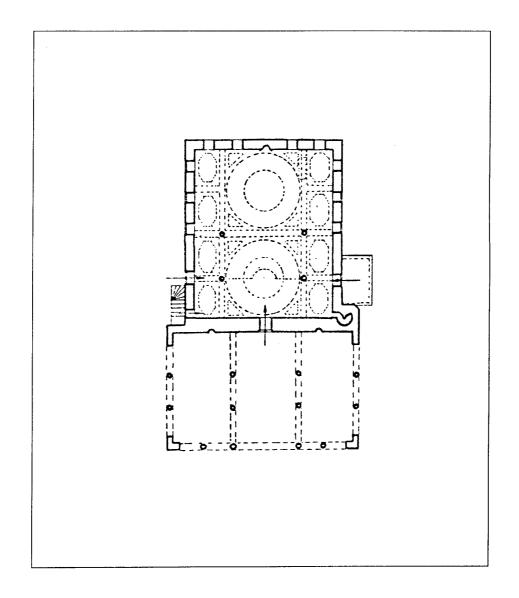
مكرر) مسقط أفقي للمسجد العتيق أو القديم (اسكى جامع) في أدرنة (عن : جودوين)
